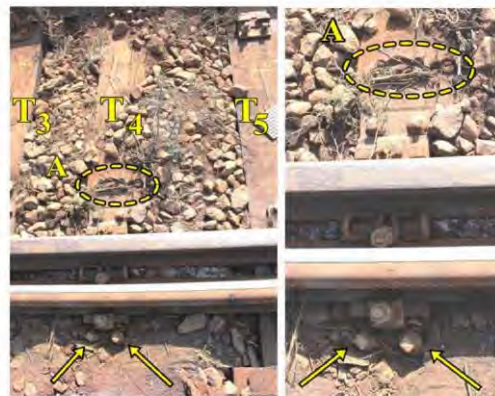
traversa T₄ traversa T₄ (detaliu A) - traversă ruptă transversal - placă metalică pătrunsă în traversă
